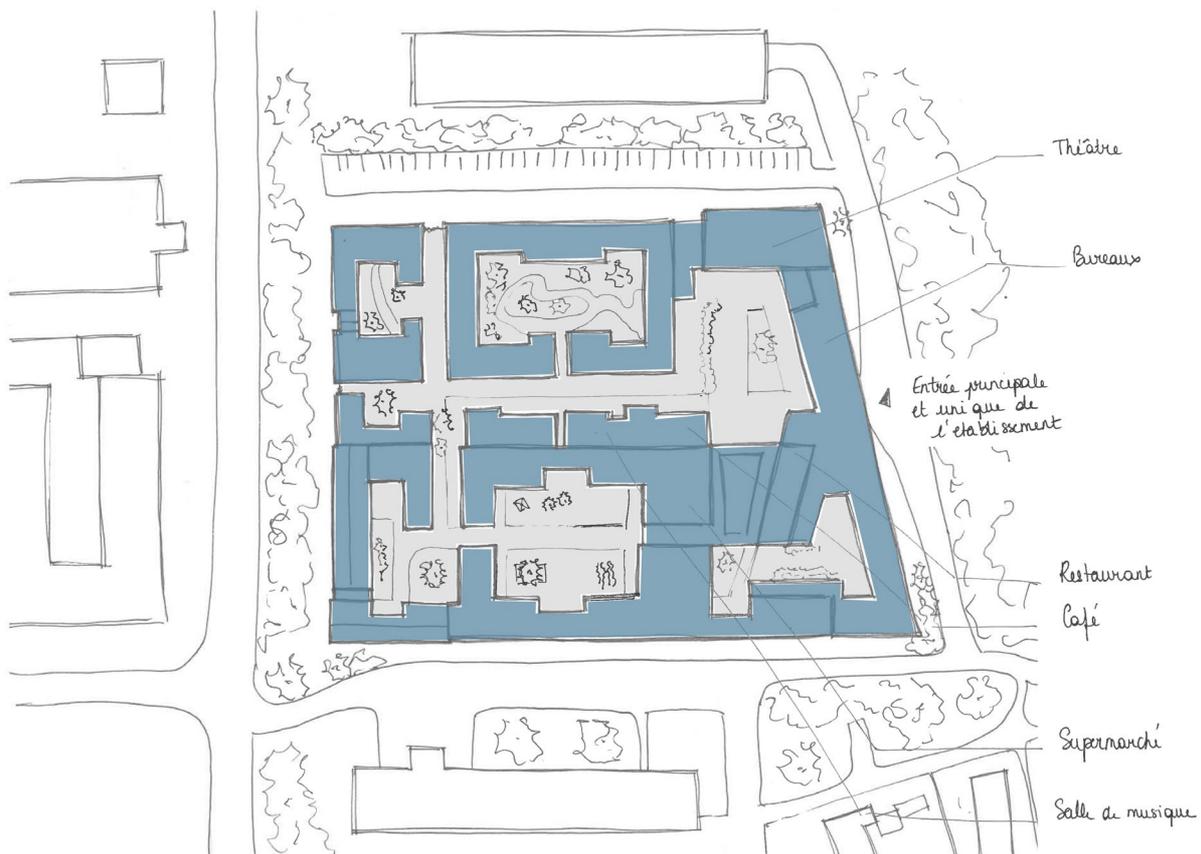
Village Alzheimer Hollande - Plan masse de l'établissement
